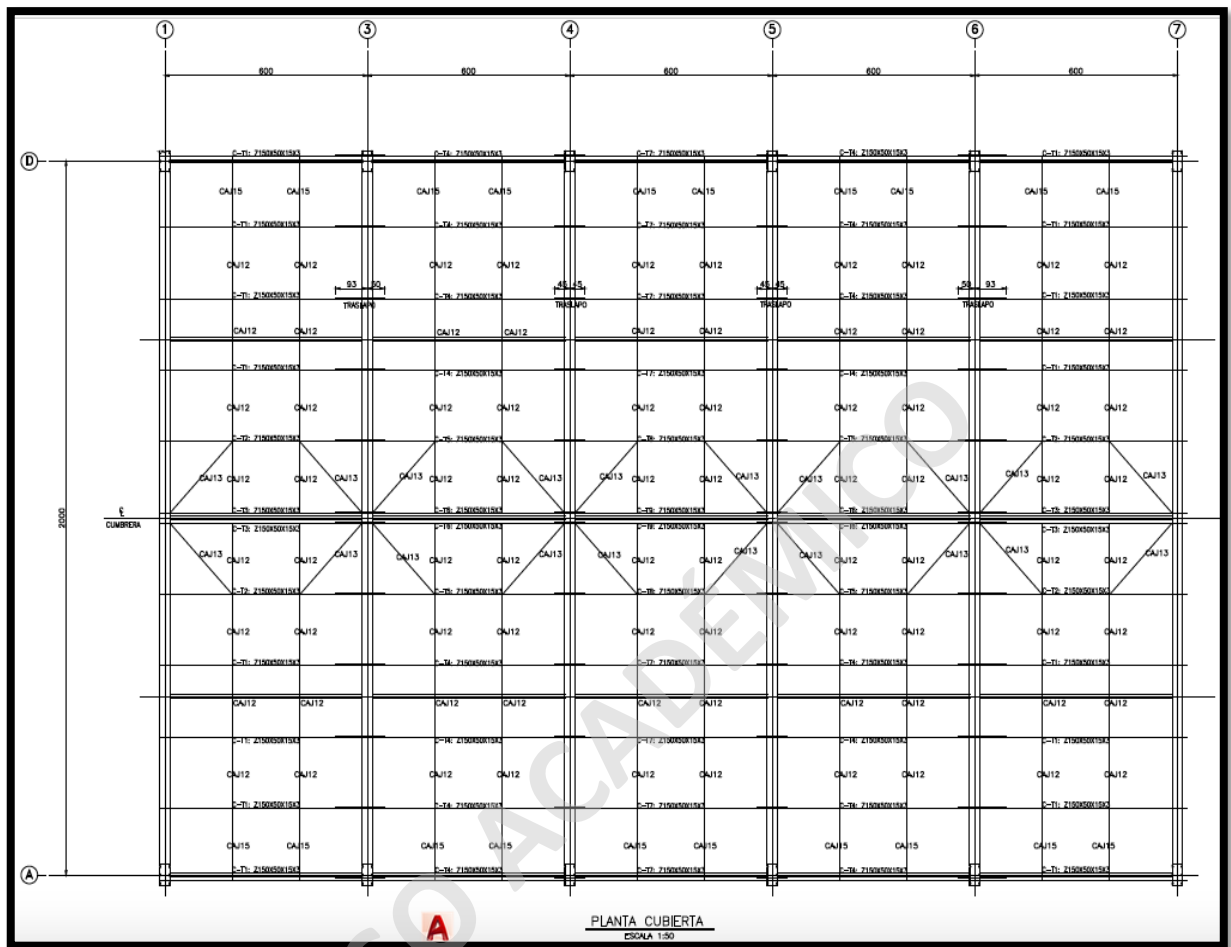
Planta de Cubierta de Colgadores ODR Ingeniería y Montaje.
